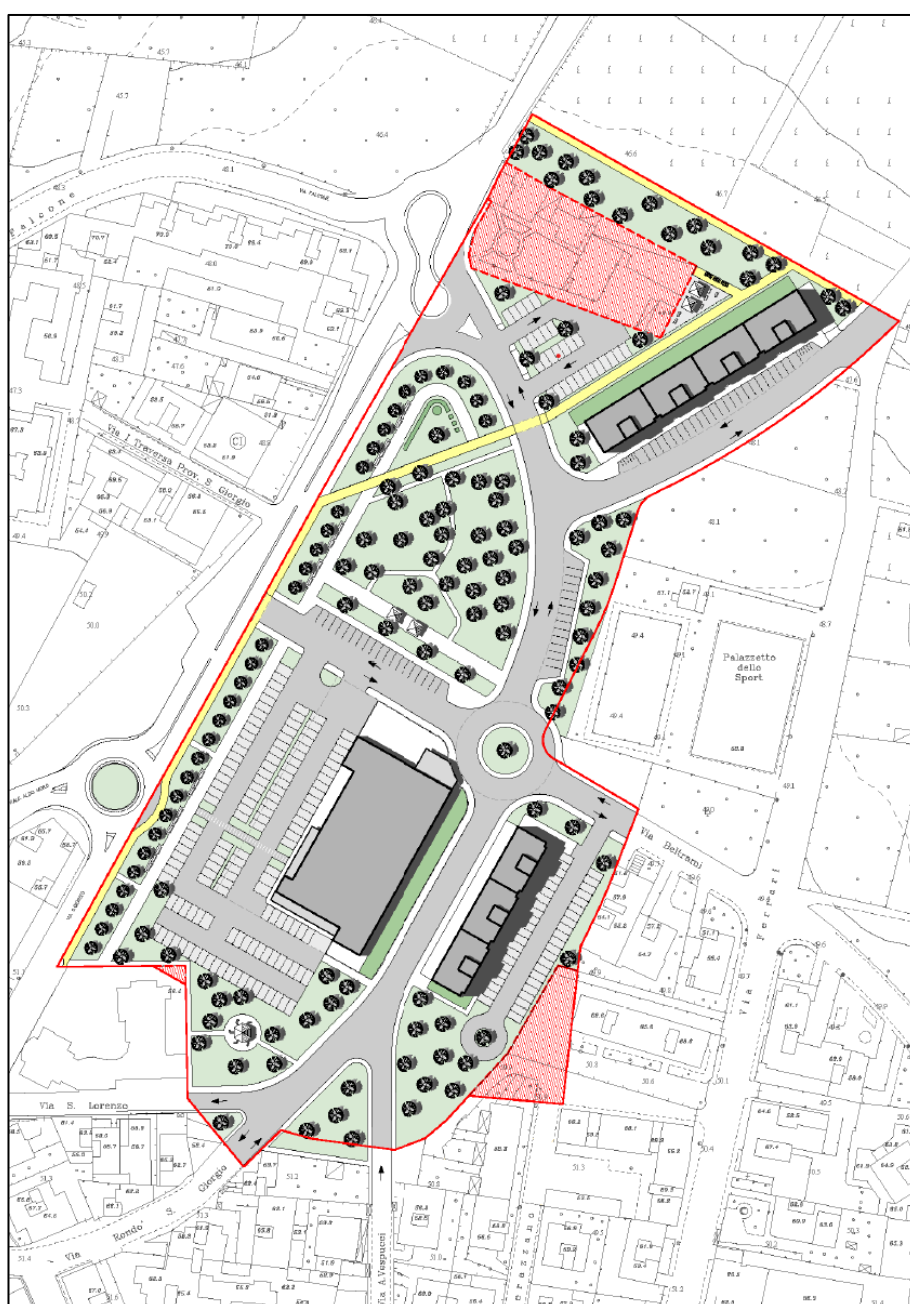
Planimetria generale del piano urbanistico aggiornato
